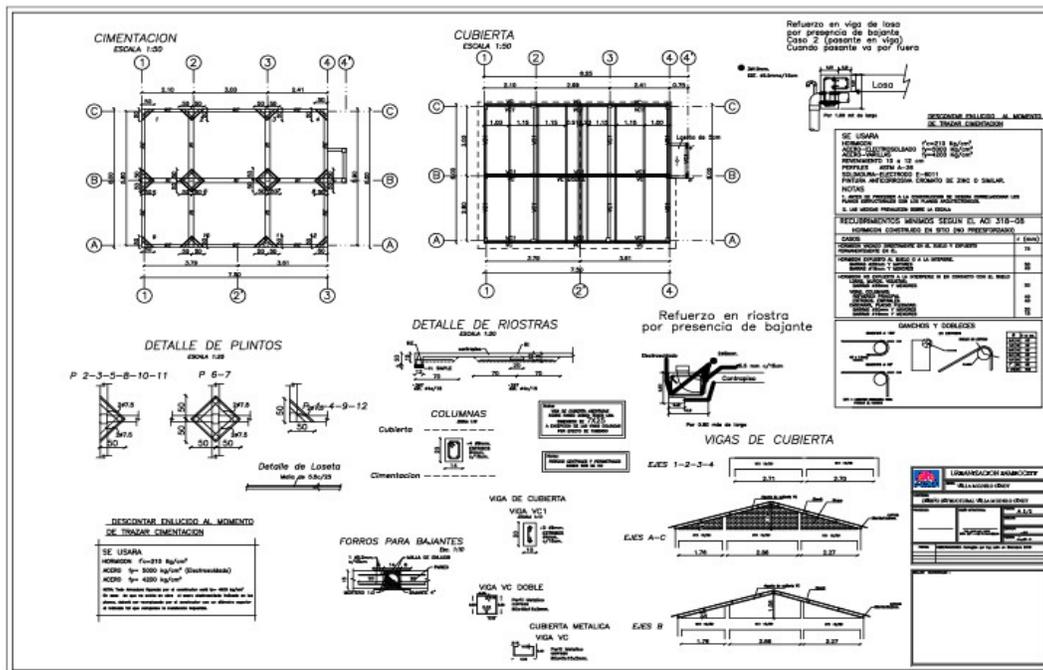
Planos Estructurales del Proyecto. Villa Modelo Cindy
